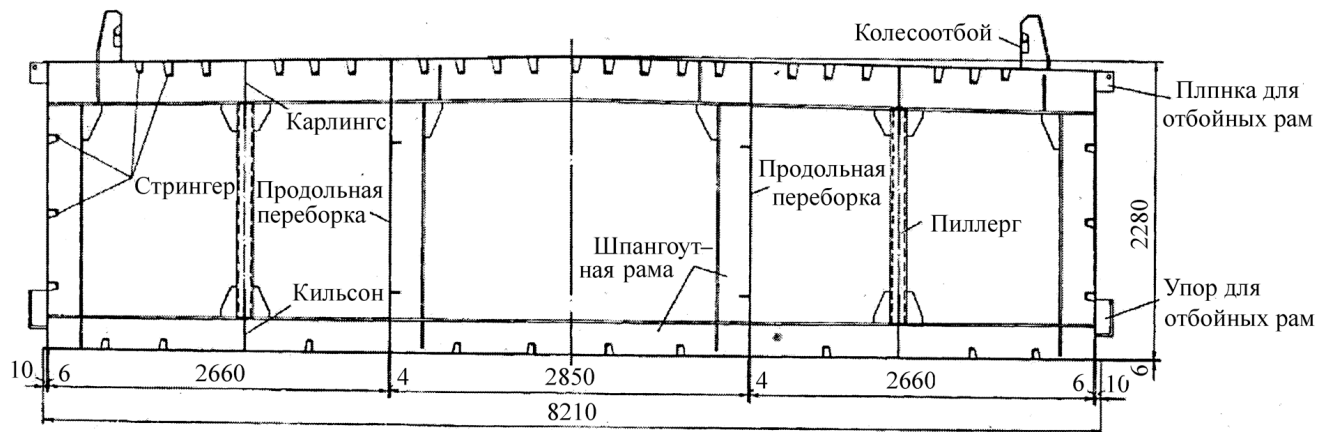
Поперечный разрез корпуса стального понтона плавучего причала
